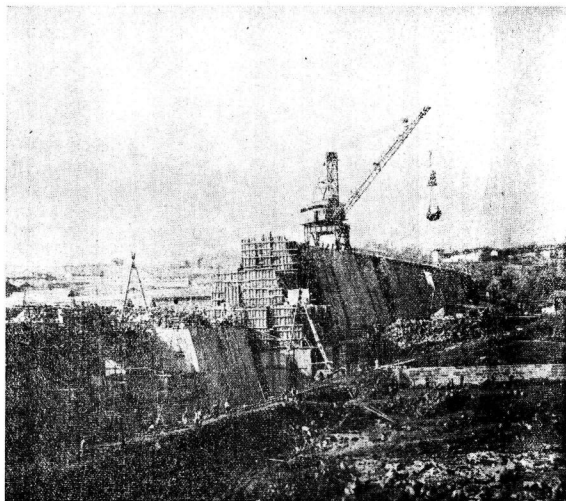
1 獅子灘大壩混凝土壩體施工吊運混凝土桶及塊石網
